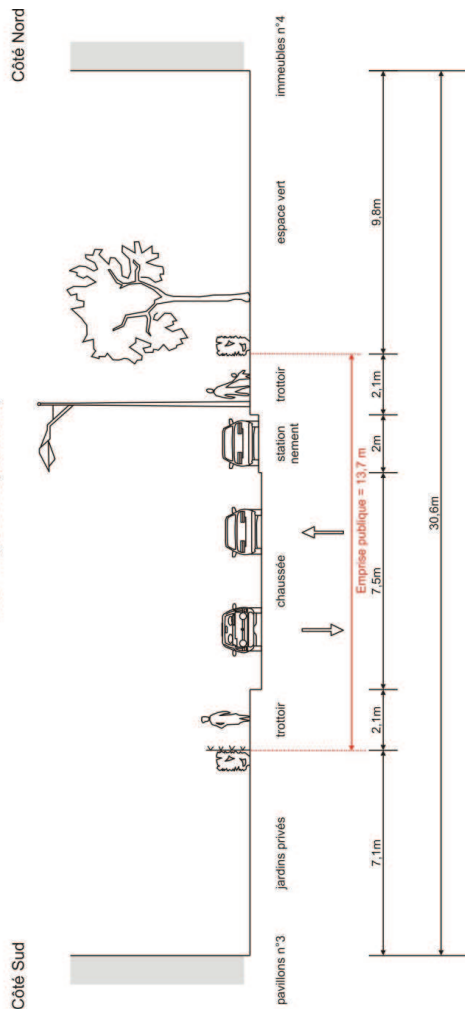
Situation initiale - coupe 10 (au niveau du 1, rue Virgile)
